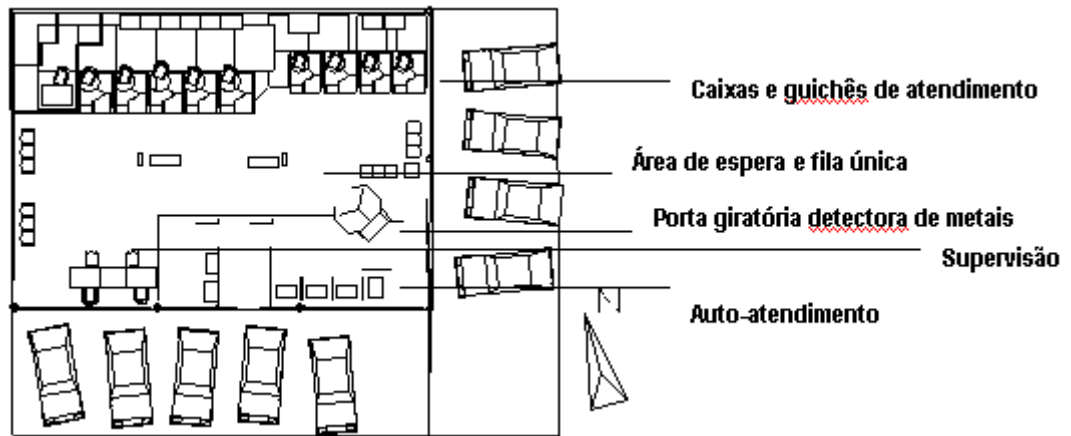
Planta baixa da agência da Caixa Econômica Federal, pavimento térreo em esquina, envidraçada.
